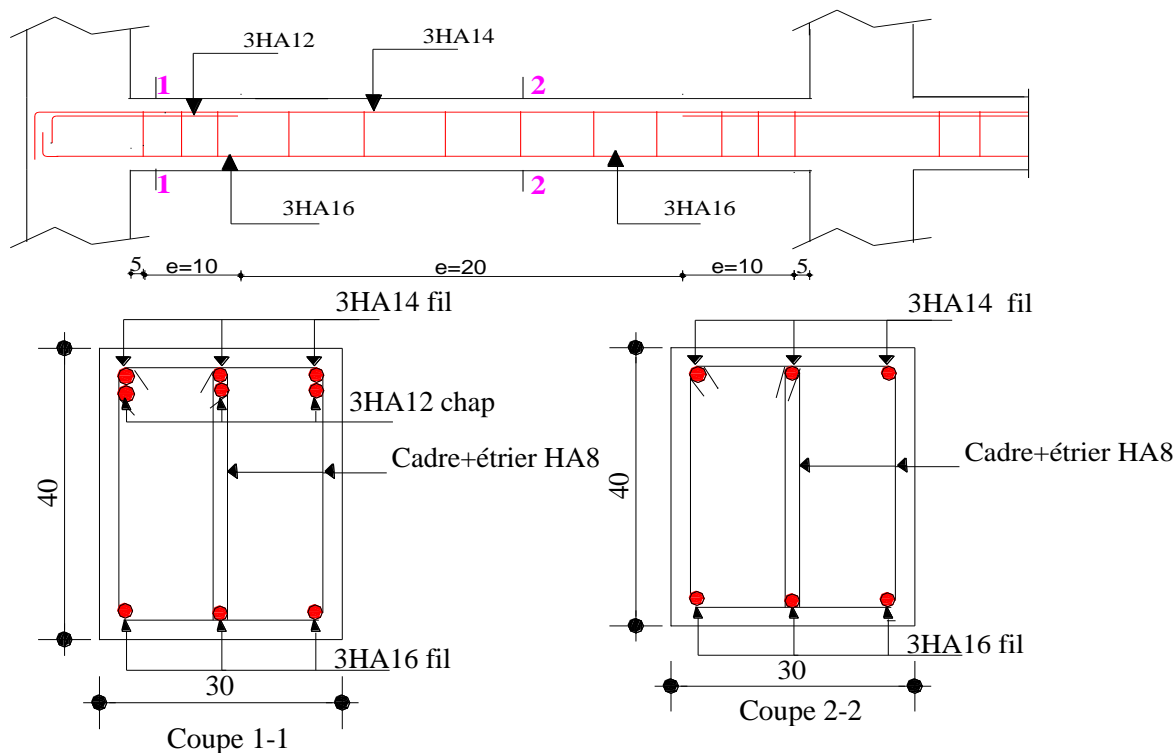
Schéma de ferrailage d'une poutre principale.
